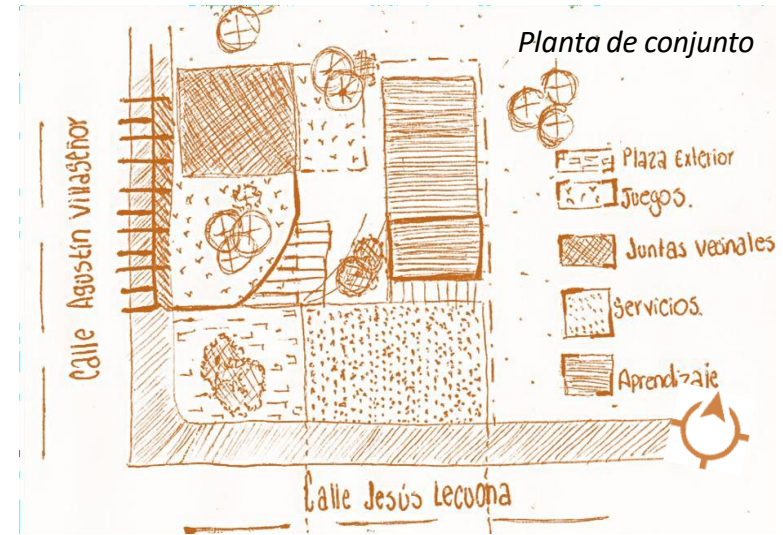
Planta de conjunto - Croquis descripción conceptual. Fuente: Elaboración propia. 2020.
